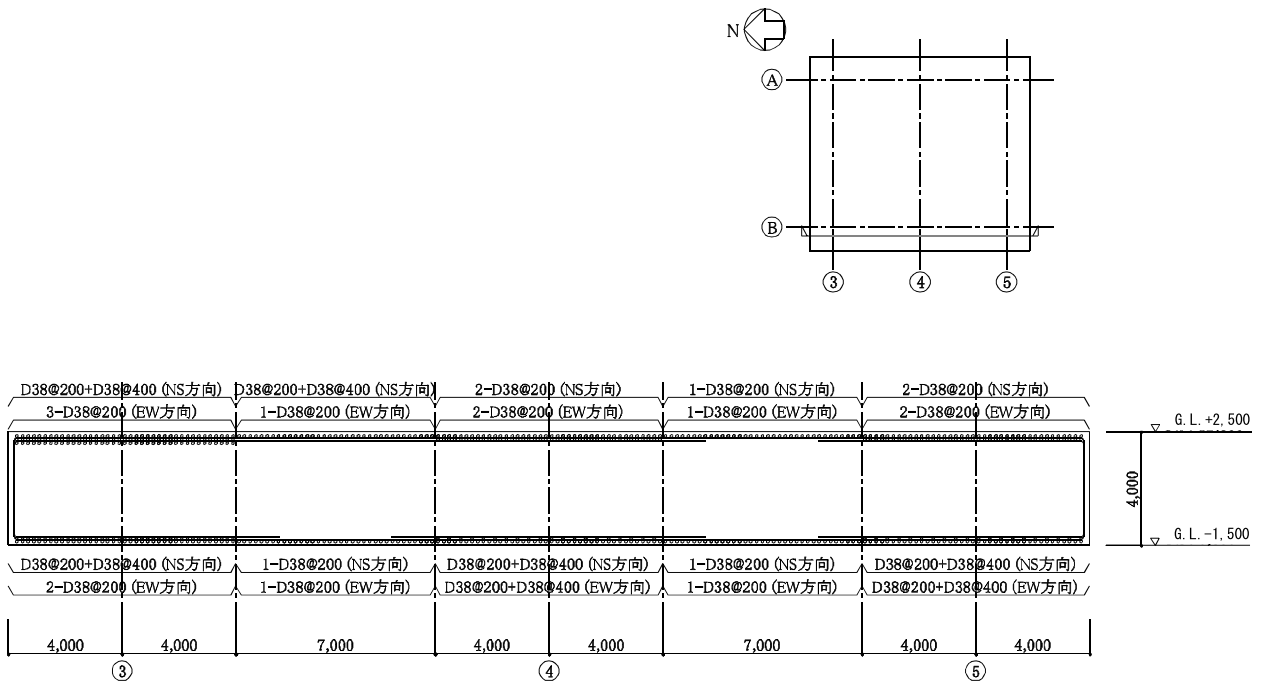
基礎スラブの配筋図 (B 通り) (単位 : mm)
